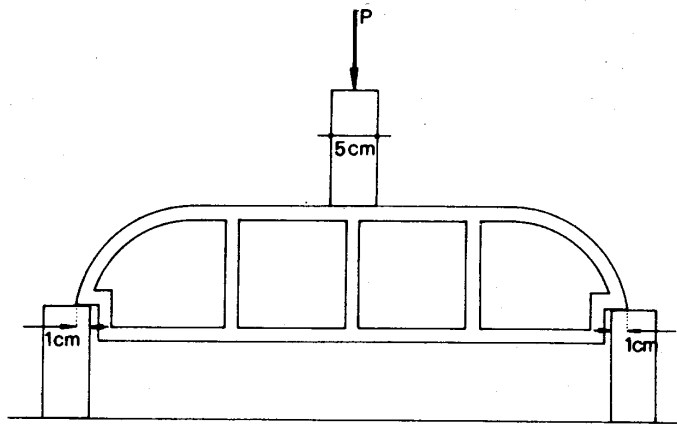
Prueba para determinar la carga de rotura en vano de una bovedilla.
